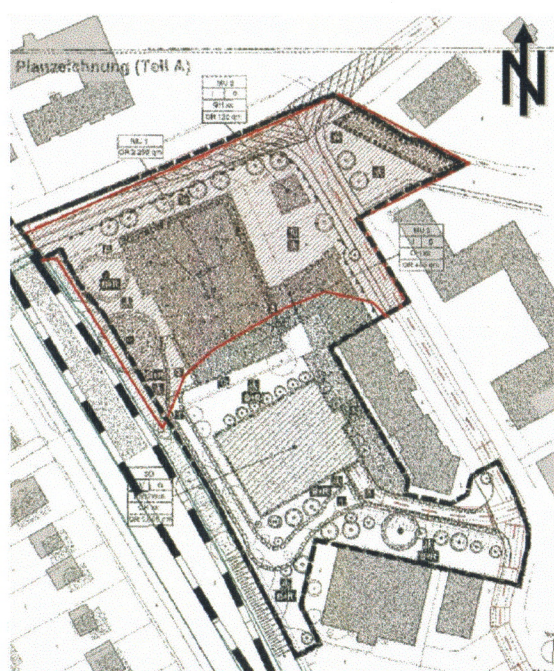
Darstellung des Bereiches in dem Außenwohnbereiche geschlossen auszuführenden sind
